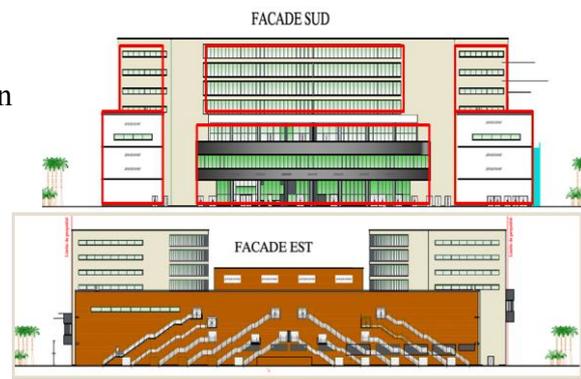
plan de façades centre de Bab Ezzouar (mémoire Bejaia 2016/2017)
